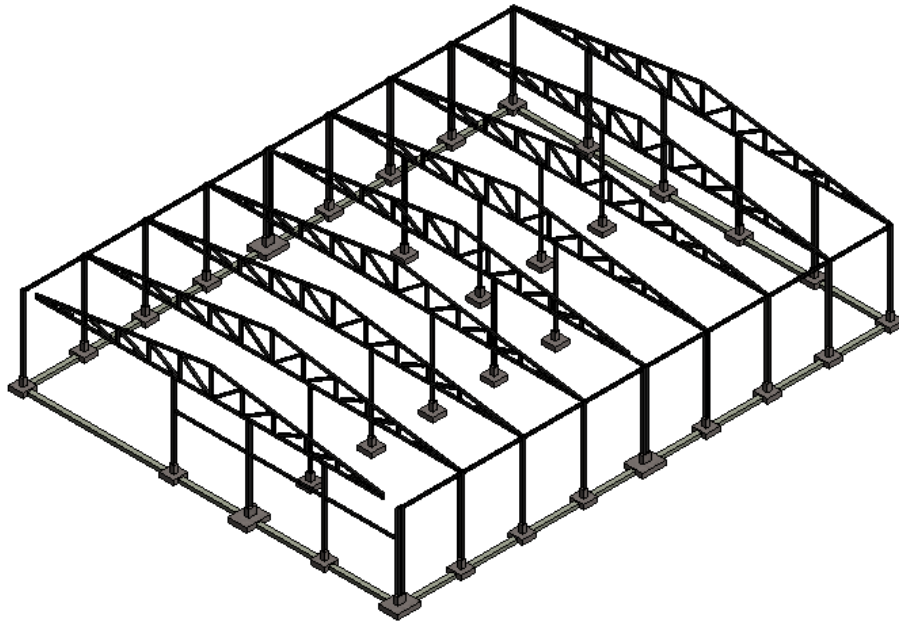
Estructura de la zona de oficinas tras disponer celosía.
